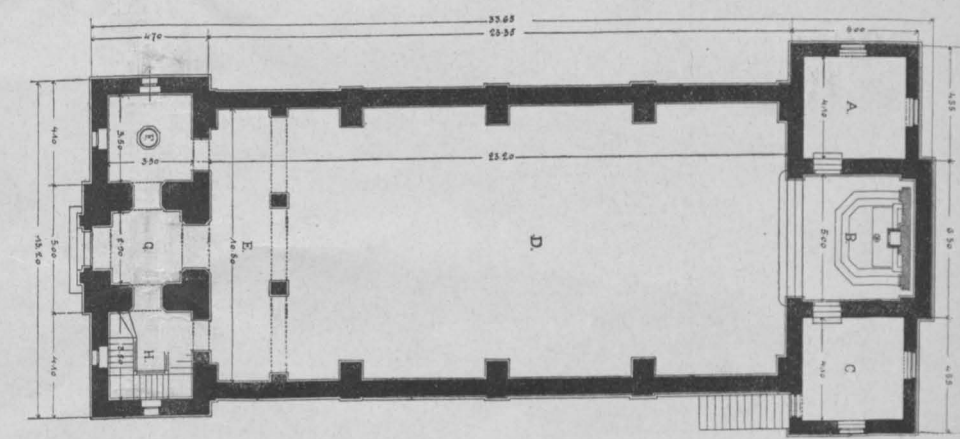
Grundriss der Kirche in Bosn.-Brod.
